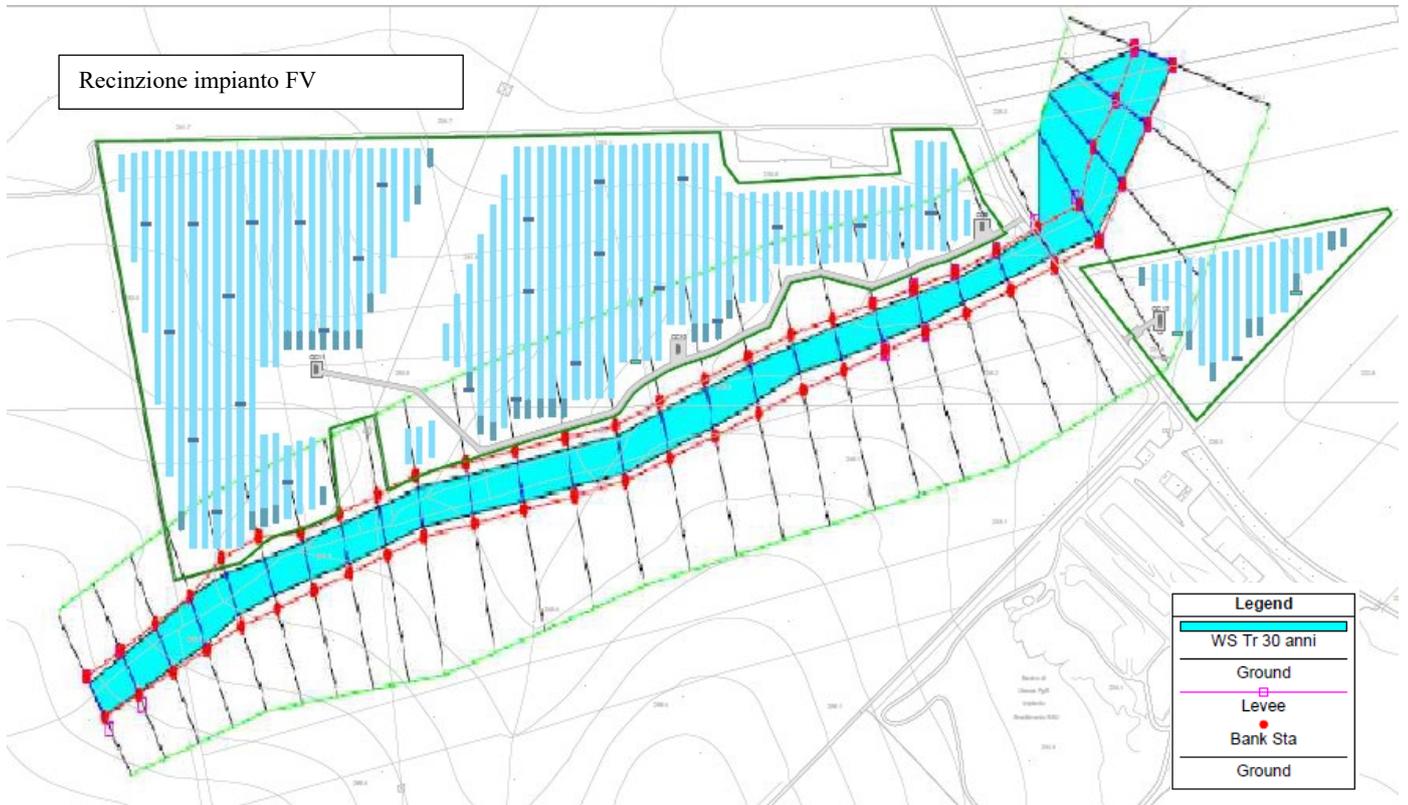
Planimetria con le sezioni trasversali e le aree di alluvionamento per portate con TR\_30\_Canale Sud
